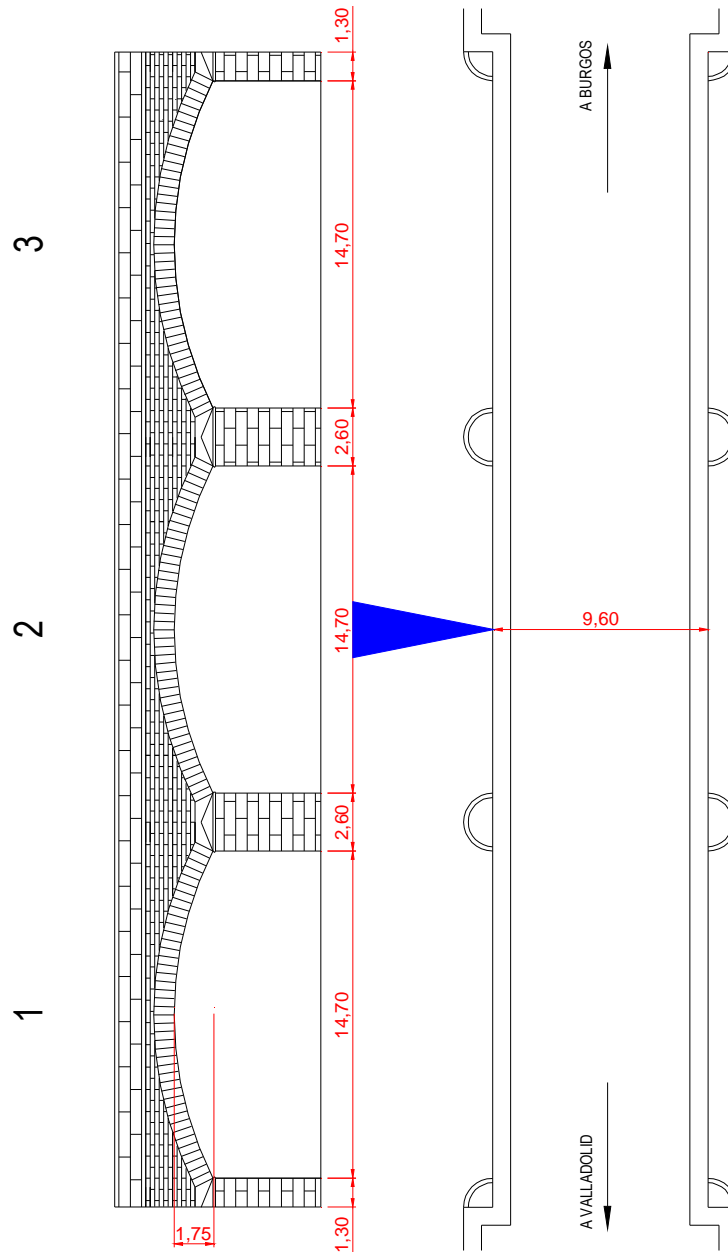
Planta y alzado de aguas abajo del puente de San Isidro en Dueñas
